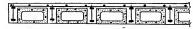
80. Армирование балочных плит над опорами двумя сварными сетками с поперечным расположением рабочих стержией.
